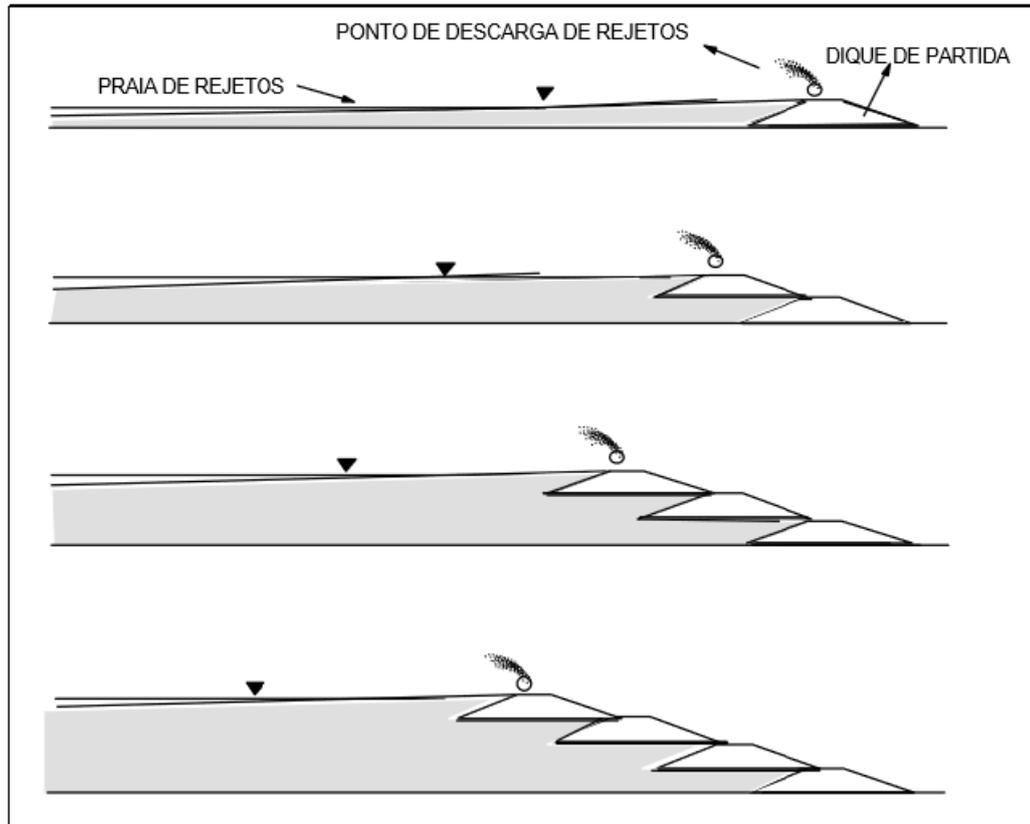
Método alteamento para montante na construção de barragem de rejeitos. Fonte: Adaptado de Vick (1983).
